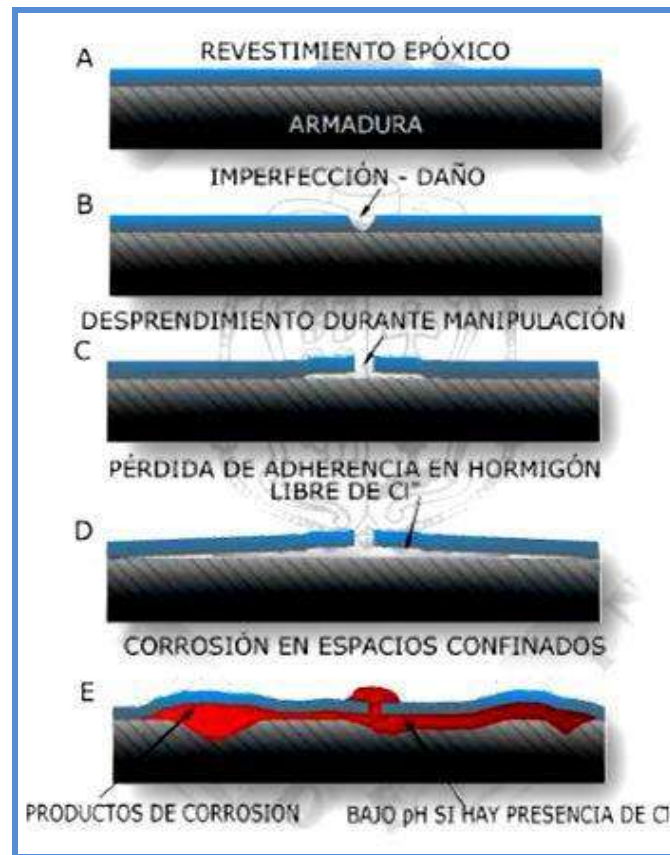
Corrosión en armaduras recubiertas con epóxicos.
